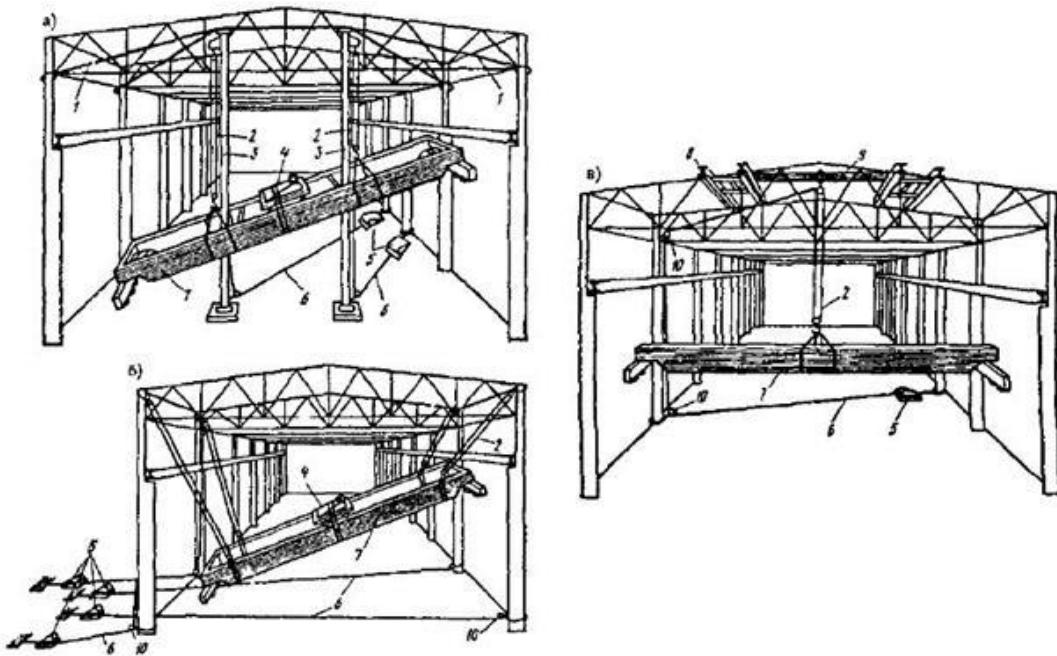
Схемы монтажа мостового крана в здании насосной станции
